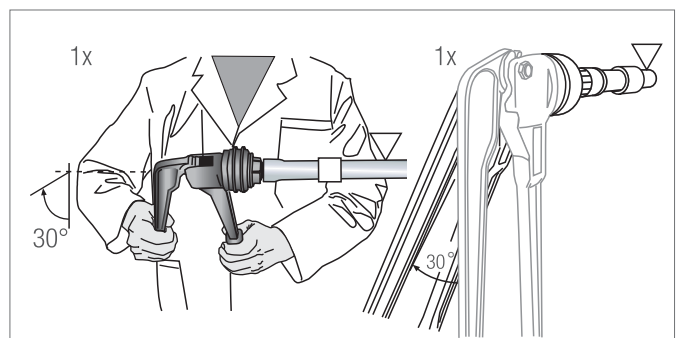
Sin cambiar la posición del tubo, girar la herramienta expansora 30° y abocardar nuevamente el extremo del tubo.
